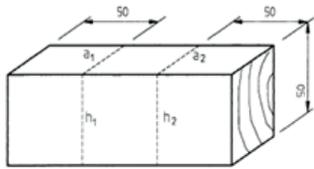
Ensayo de compresión perpendicular a las fibras.
